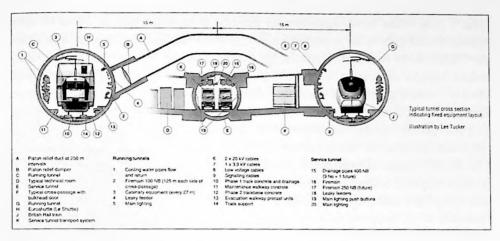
Tunnel sottomarino della Manica: schema di sezione progettuale.
